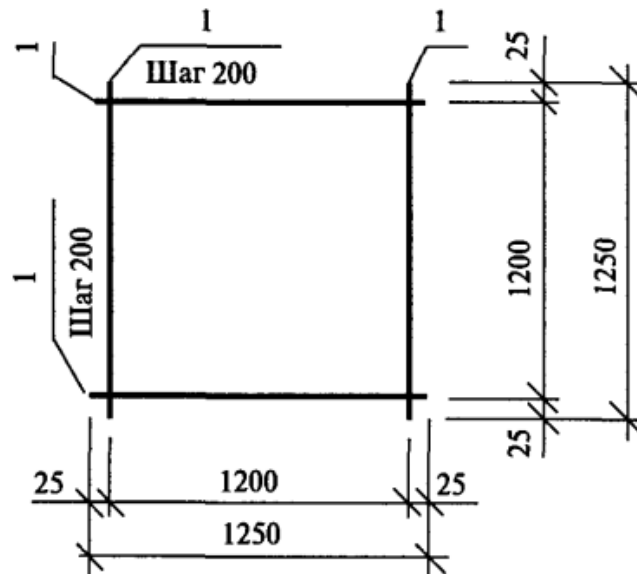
Конструкция арматурной сетки – к примеру 12.3
